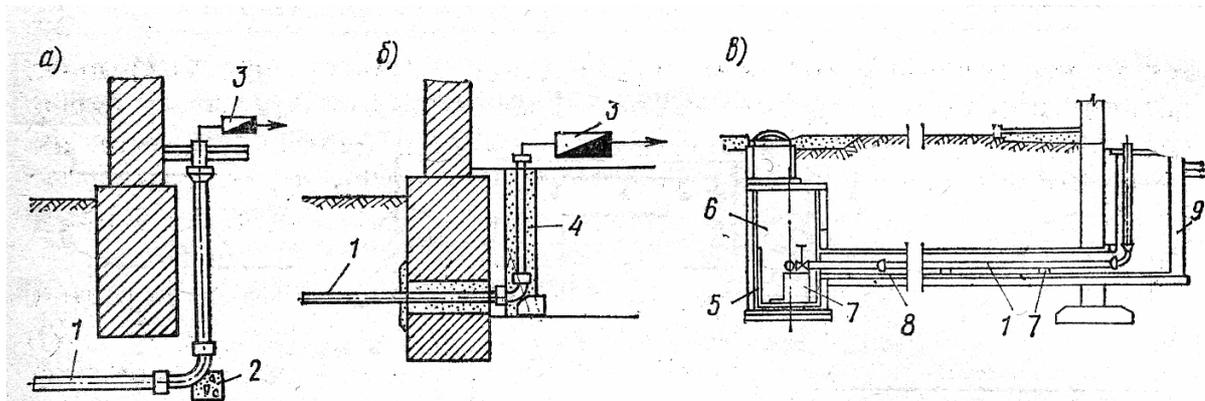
Схемы прокладки ввода ниже фундамента(а), через фундамент здания(б), в просадочных грунтах(в).
